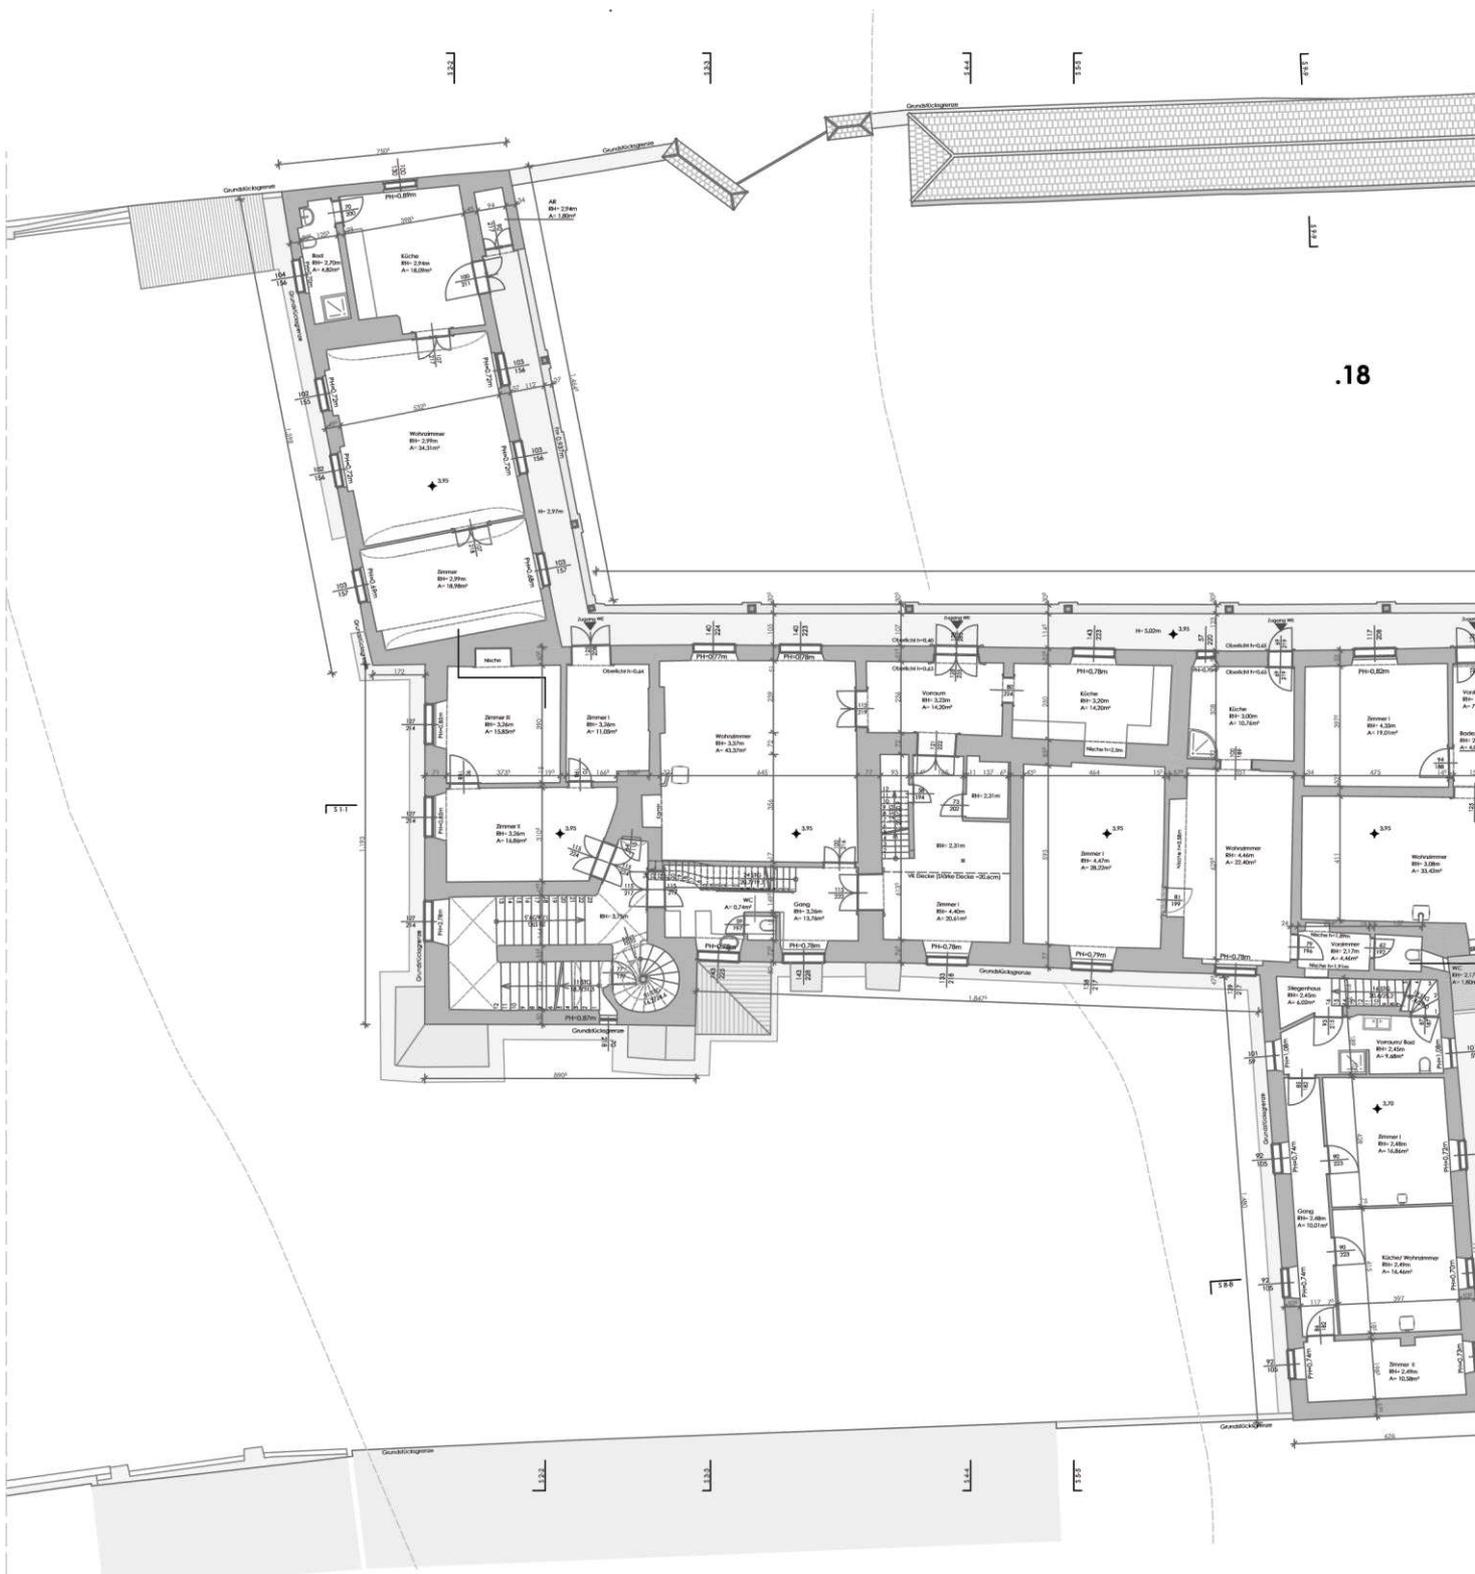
Bestandsplan Grundriss 1.Obergeschoss M 1:250
